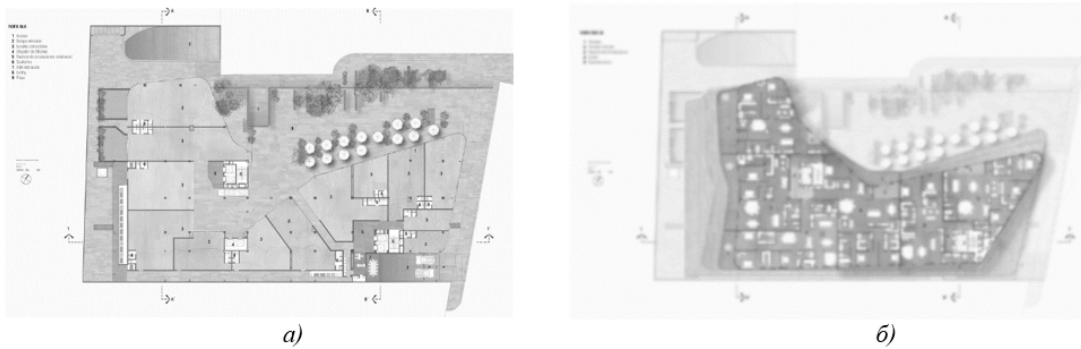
Многофункциональный комплекс High Park: а – план первого этажа; б – план четвертого этажа
